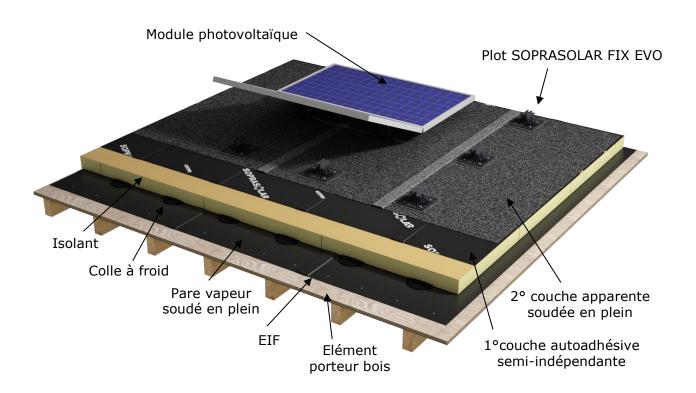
Exemple de cas du procédé SOPRASOLAR FIX EVO sur élément porteur bois ou à base de bois avec revêtement d'étanchéité bicouche semi-indépendant autoadhésif
